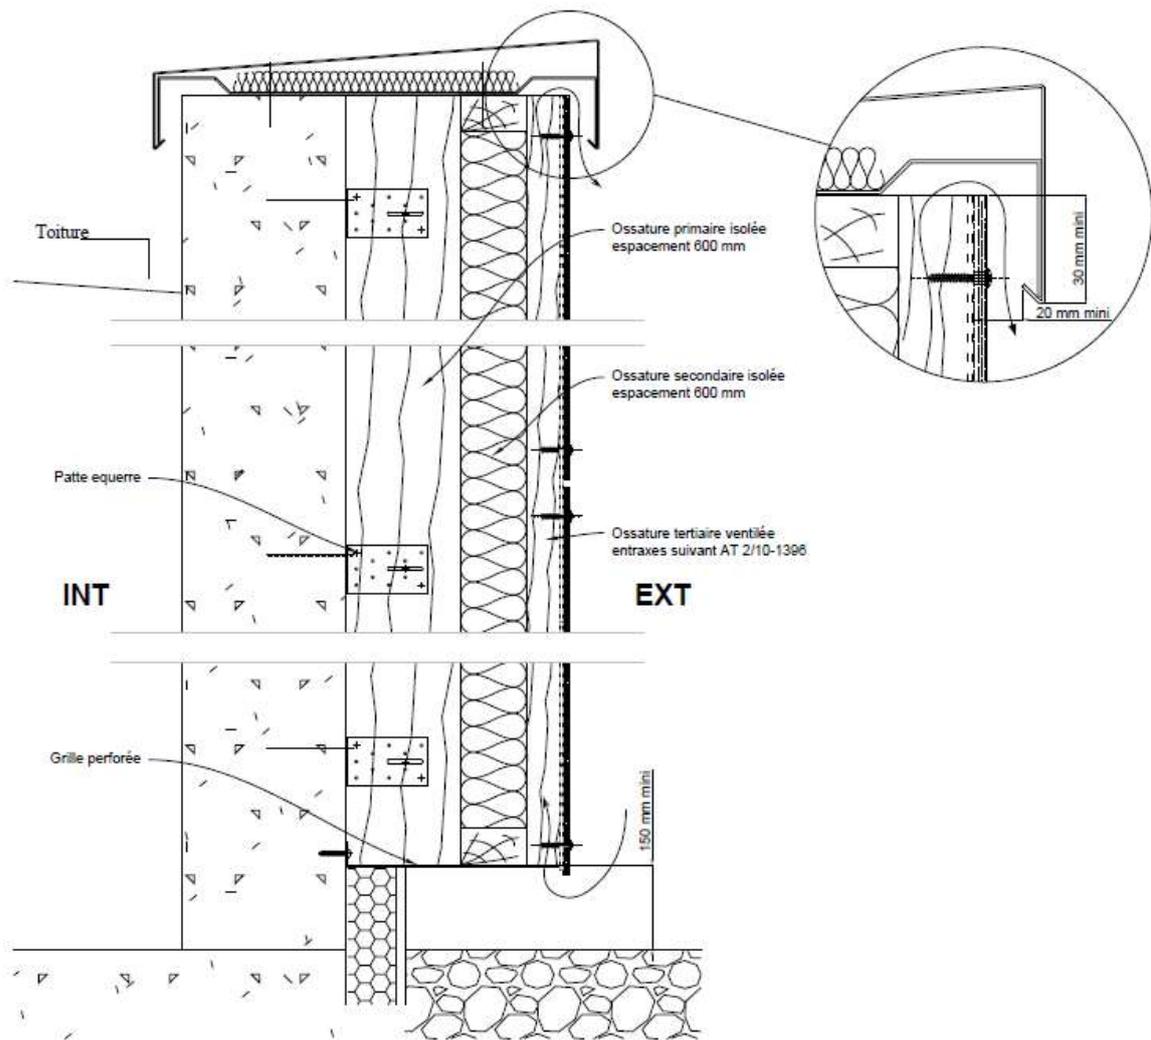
Traitement sur BA en multi réseau sur béton - Coupe verticale générale
